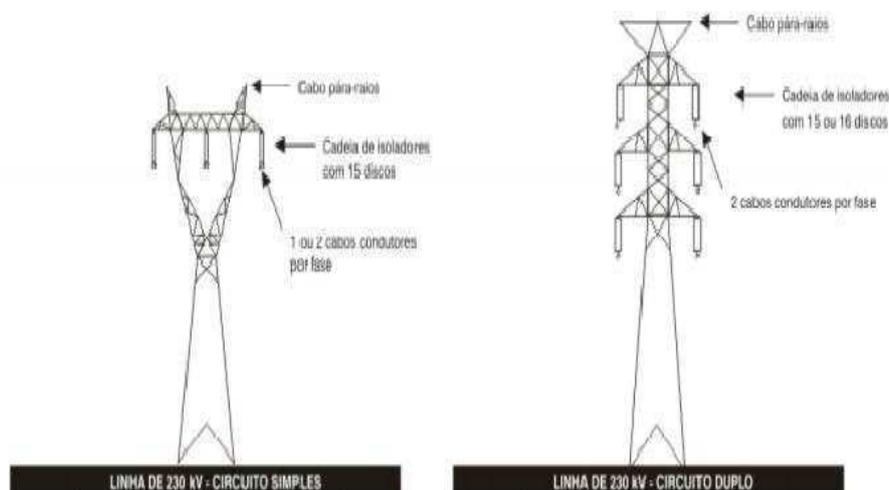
Ilustração de estruturas tipo suspensão (RANGEL, 2009)
